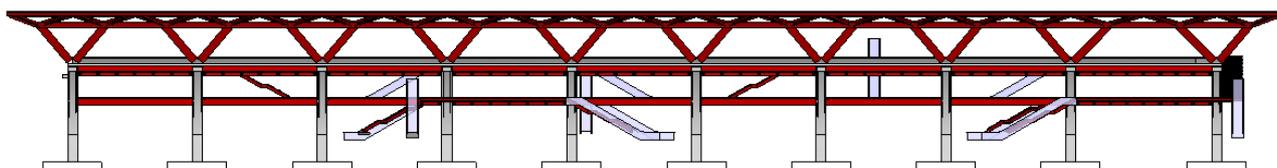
Sección longitudinal de la estructura de la estación elevada del TITM.
